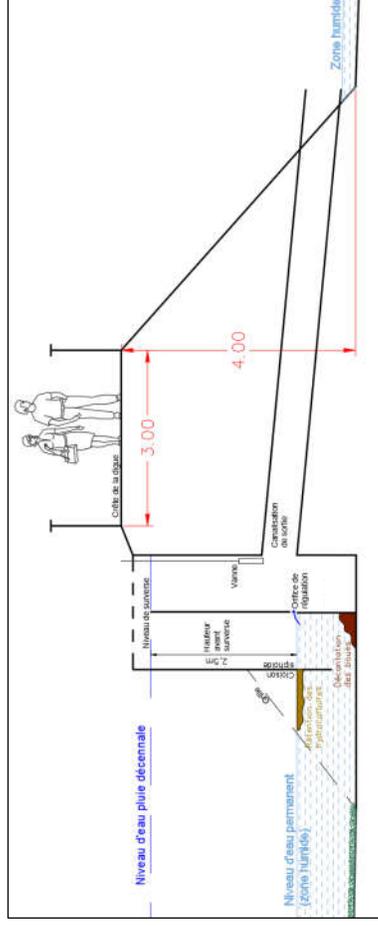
Coupe type de l'ouvrage de sortie (Source : ANC Concept)
